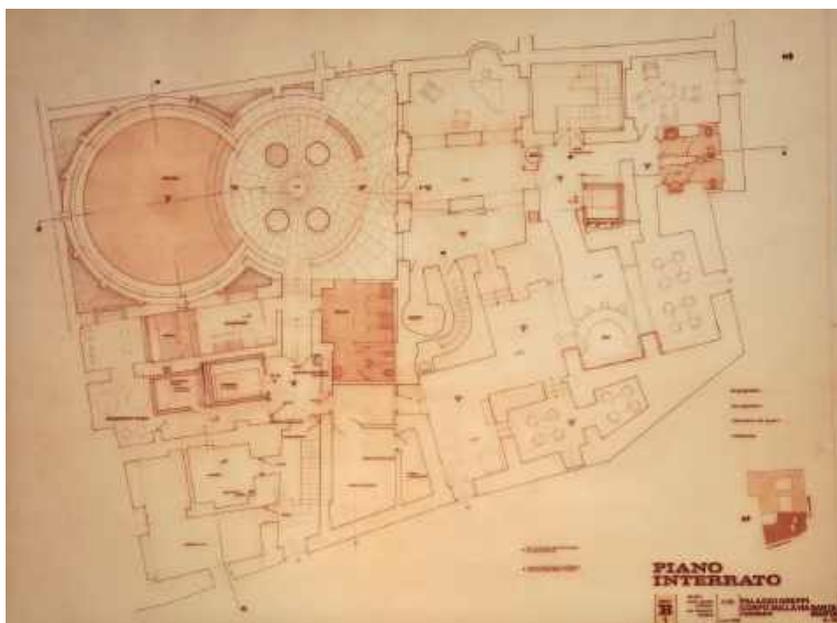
Corpo su via Santa Marta, pianta piano interrato, progetto di restauro e ristrutturazione; tavola su lucido
